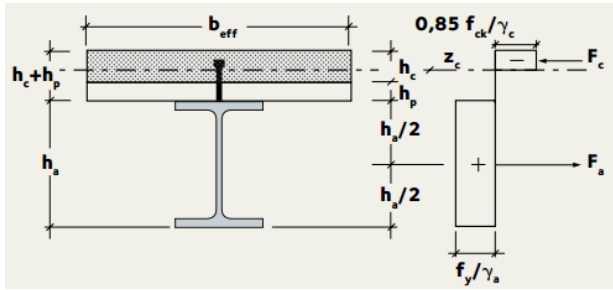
Acción mixta entre la losa de hormigón y la viga de acero.
